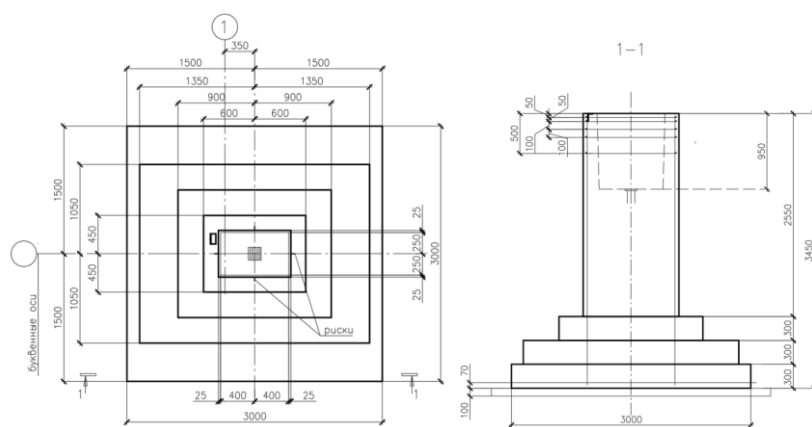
Фундамент монолитный ФМ-3 (3х3 м)
